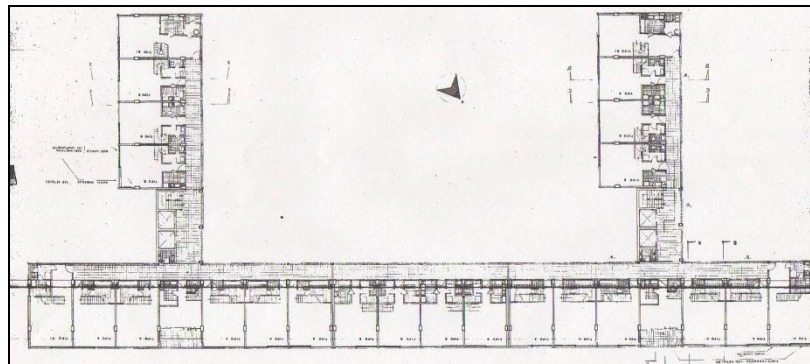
n. Superbloque UR El Paraíso. Planta General. Nivel Inferior Apartamentos Duplex
